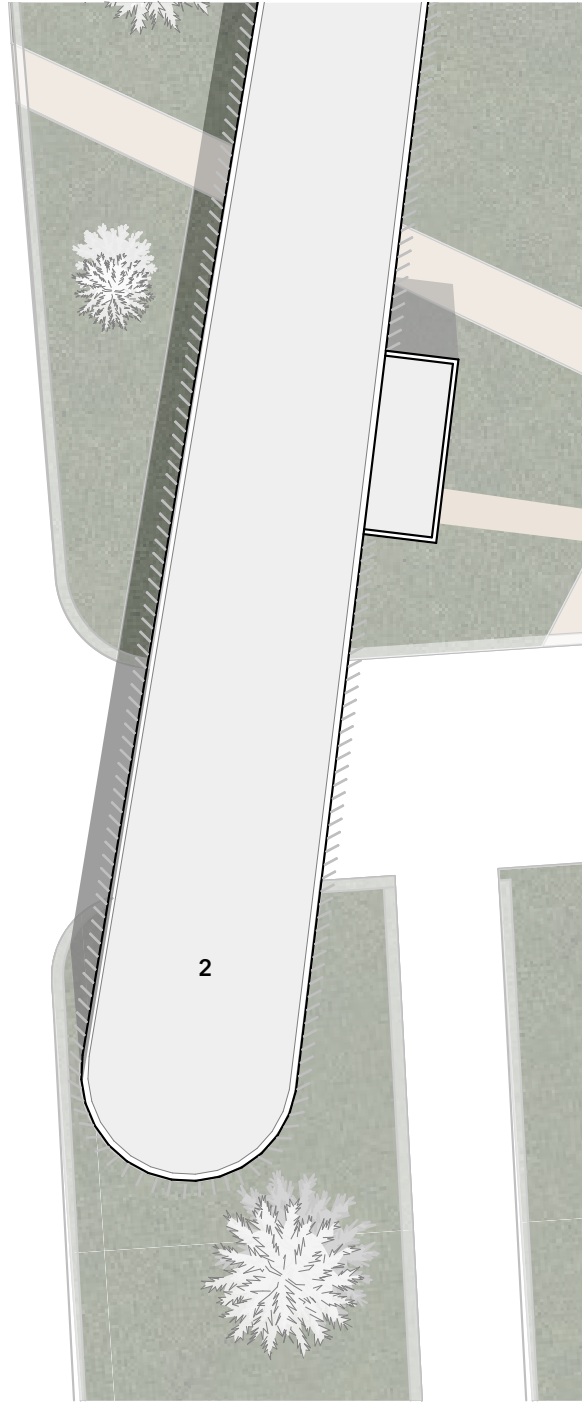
, Grundriss OG2, eigene Darstellung
